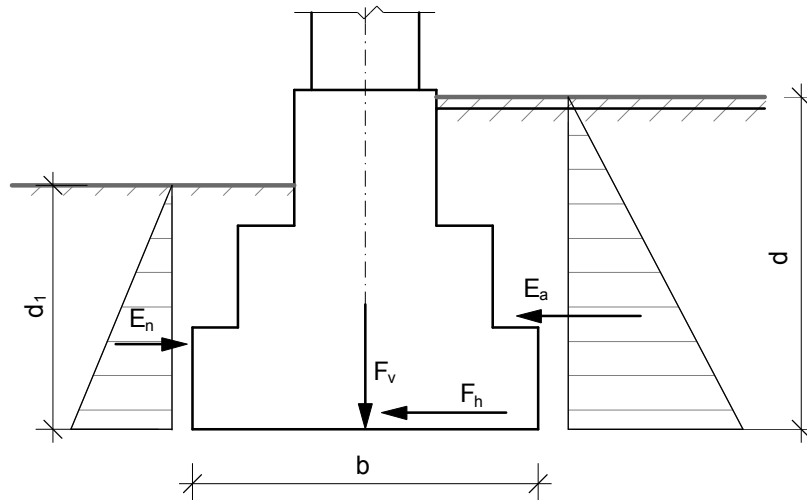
Розрахункова схема для розрахунку фундаменту на зсув по підшві
